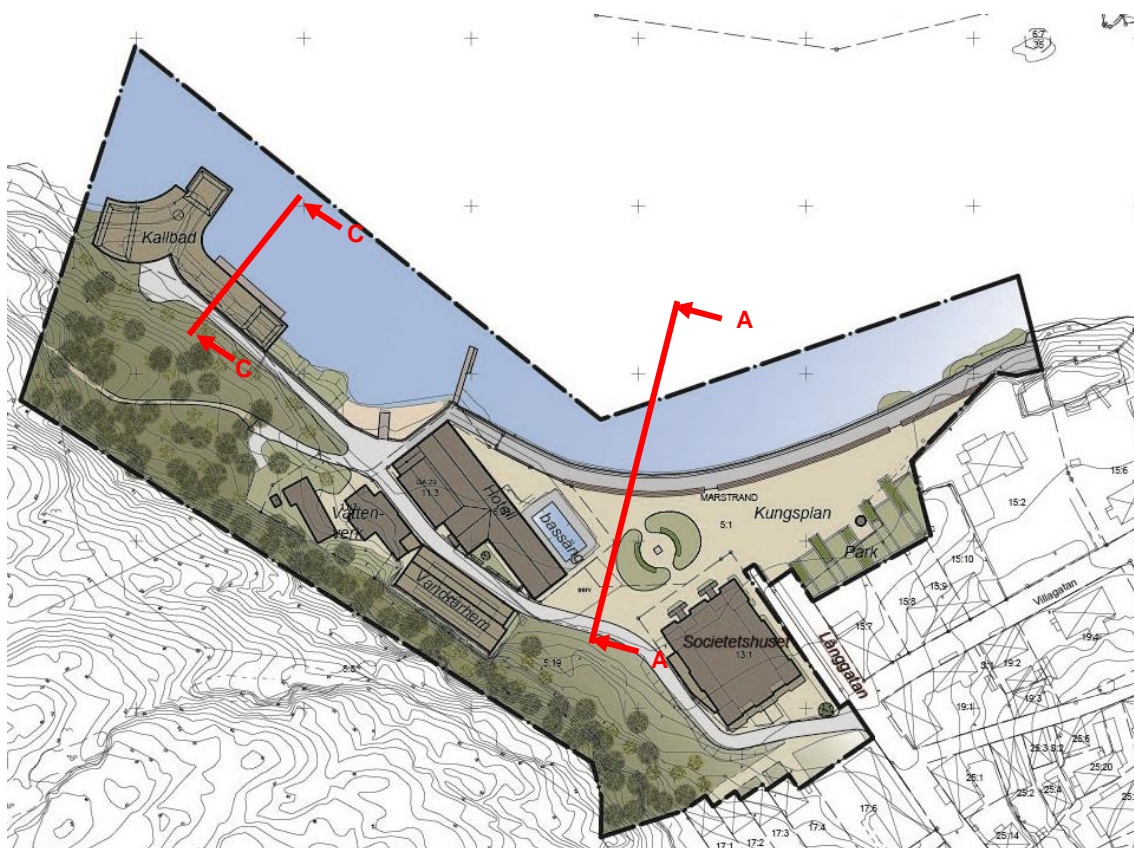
Beräkningssektion A och C. Utformning med planerad verksamhet enligt detaljplan.
